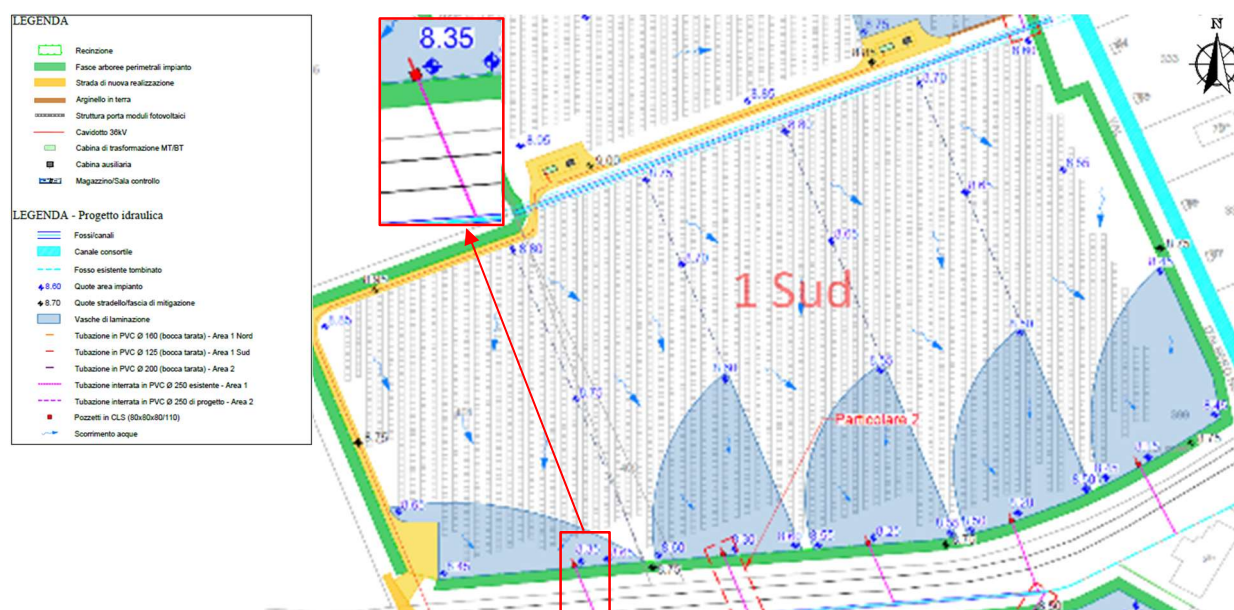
Individuazione vasche di laminazione area 1 sud (stralcio Tav. 43A)
